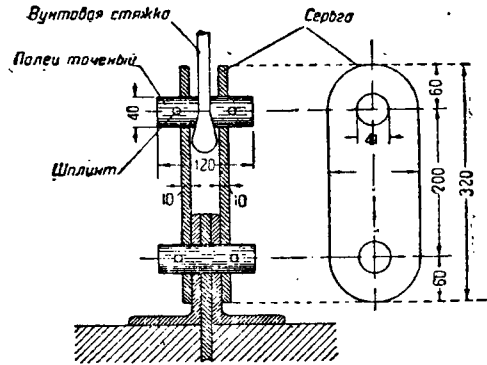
а. Железобетонный анкер мачты высотой 75 м (фиг. 21б)
